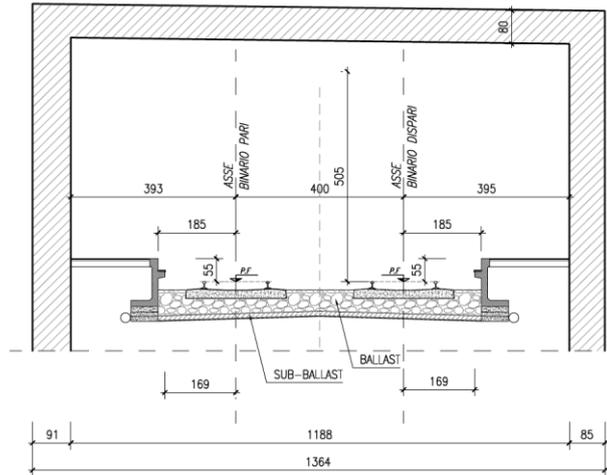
Sezione tipo in corrispondenza dello scavalco esistente.
